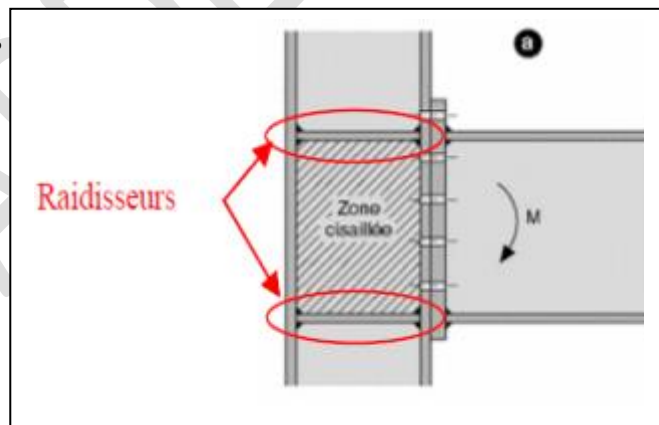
Différents types d'encastrement Poteaux / Poutre
